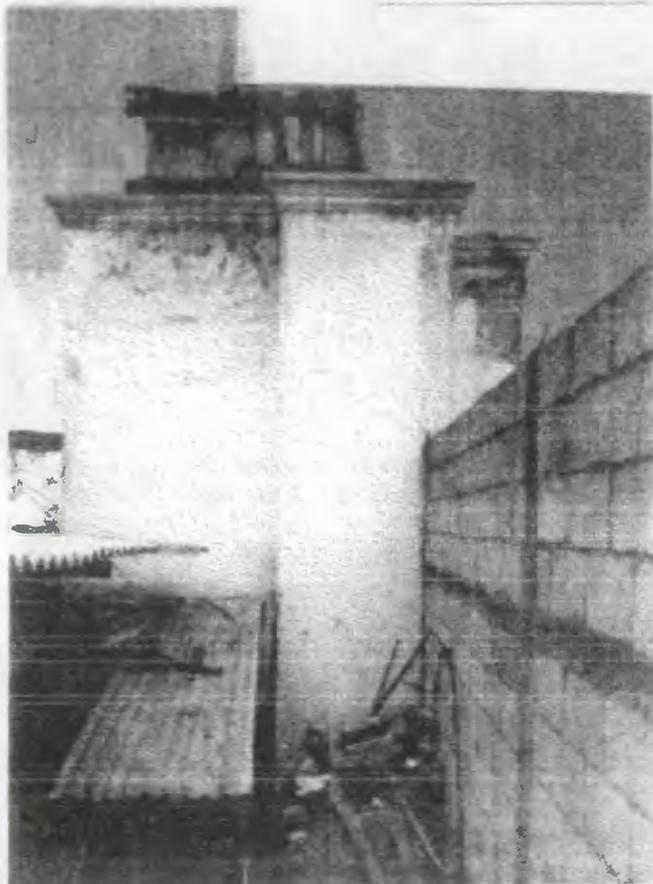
Vista del contrafuerte, donde se puede observar el abandono y deterioro que presenta este elemento.
